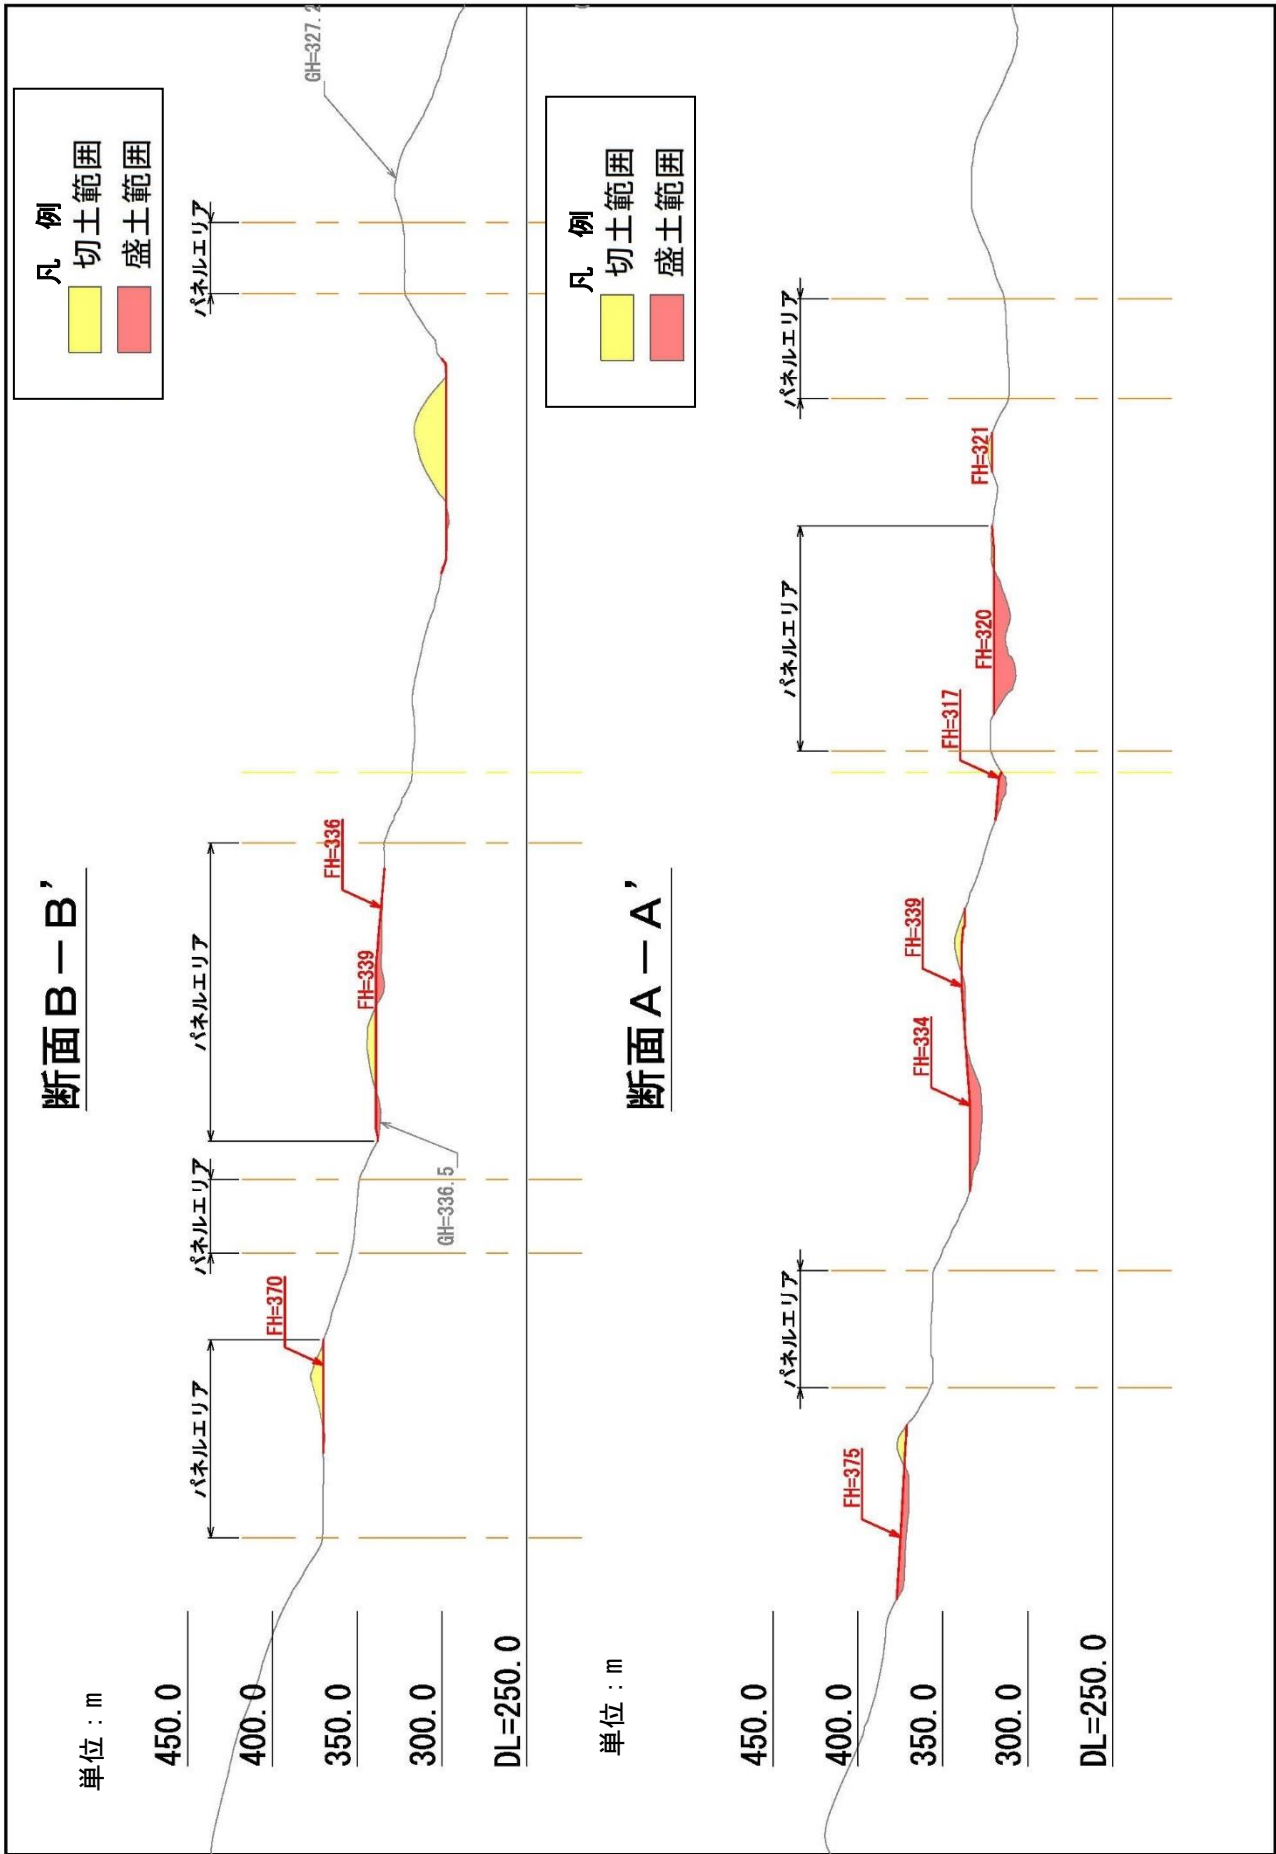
切土盛土計画断面図 (A-A' 断面、B-B' 断面)
